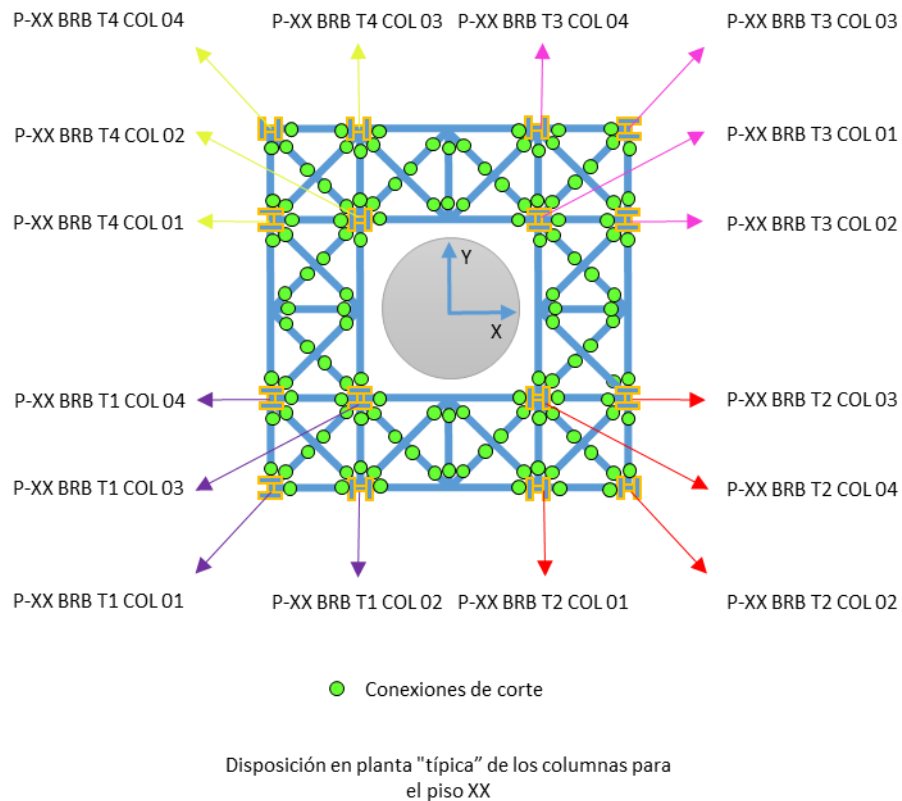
a Disposición en planta "típica" de columnas, para la estructura que considera el uso de dispositivos BRB, piso XX [elaboración propia]
